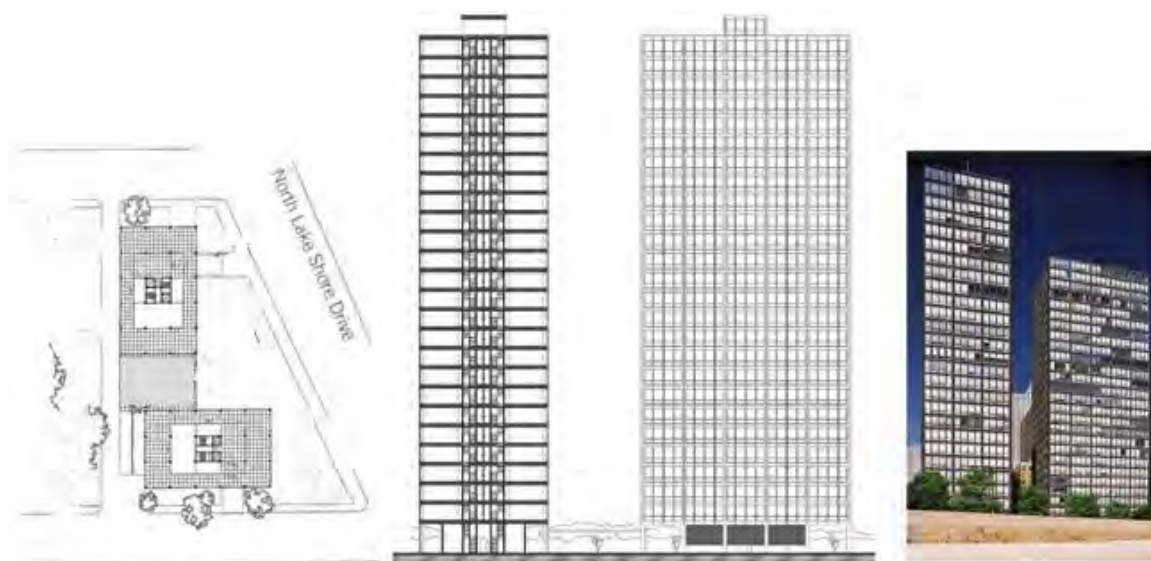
Plan de masse, coupe-façade et photo des tours d'habitations de Chicago.
